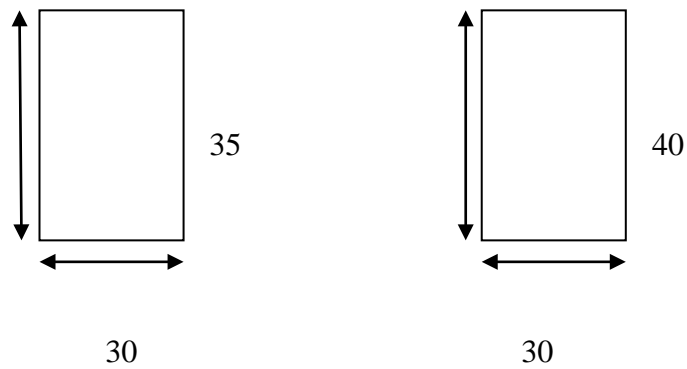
dimensions de la poutre principale et la poutre secondaire
